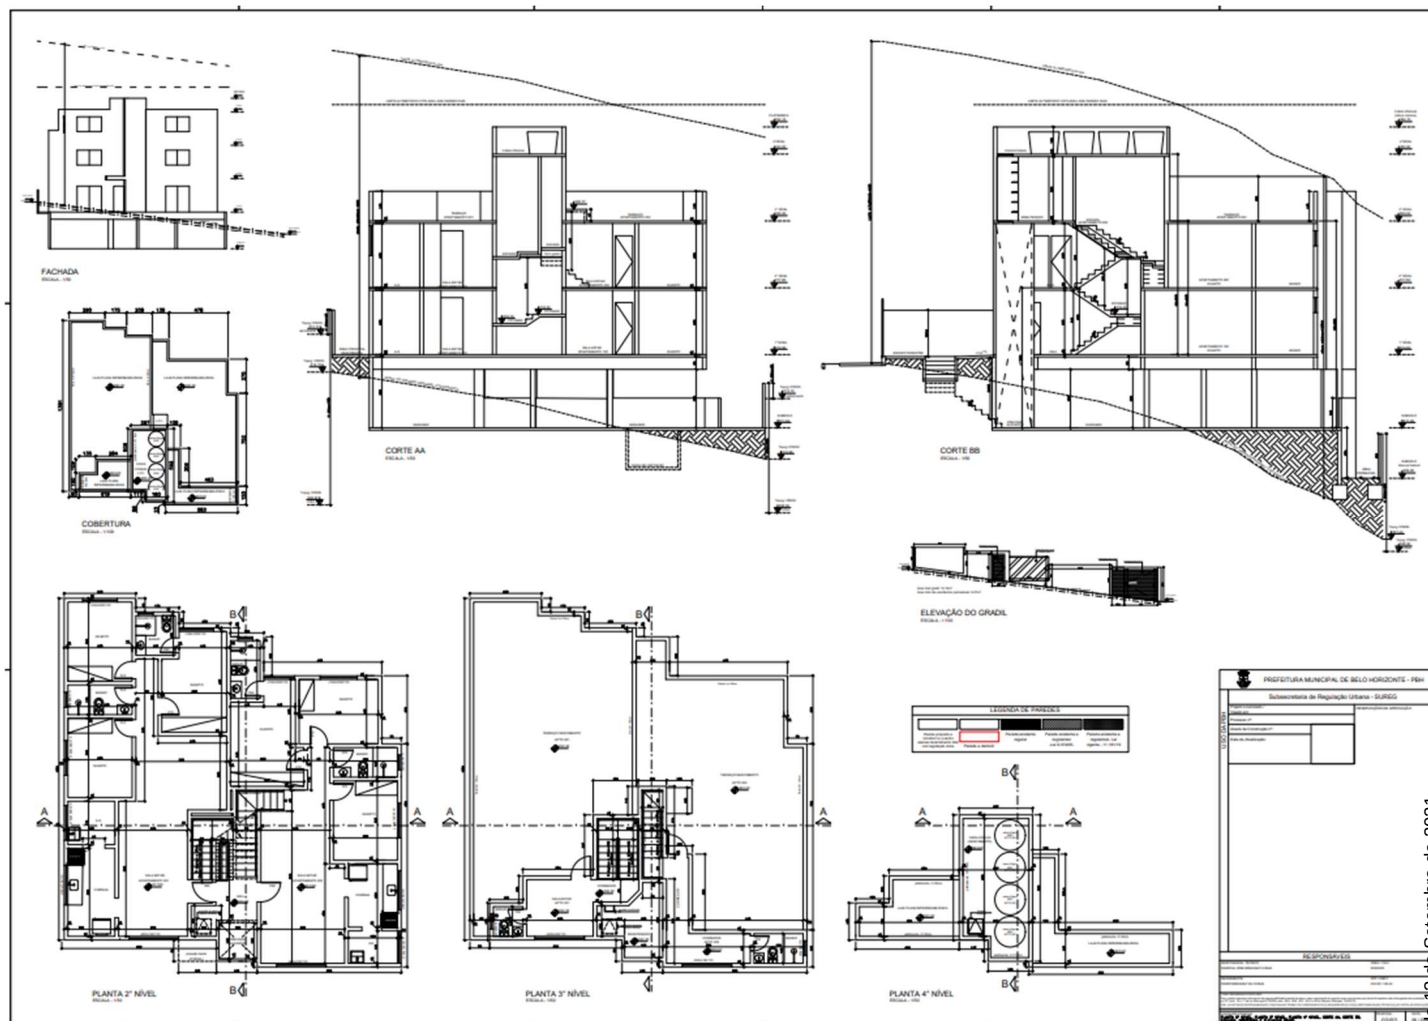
Planta baixa do empreendimento (Fonte: Empreendedor, 2025 arquivo Empreendimento Queluzita_PRANCHA 02- 02_06-2025.pdf)
